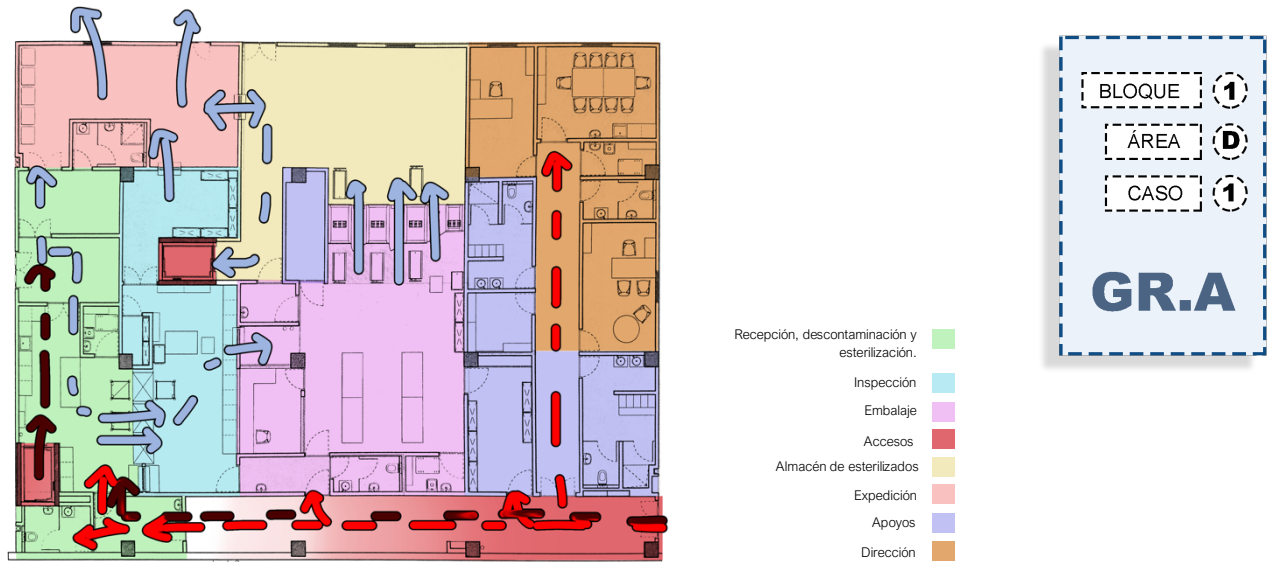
Análisis esquemático de la planta de Central de Desinfección. Hospital Loures (Saraiva, 20210). Realizado por Laura Castro. Fuente planta base: (Mendonça, 2022).
